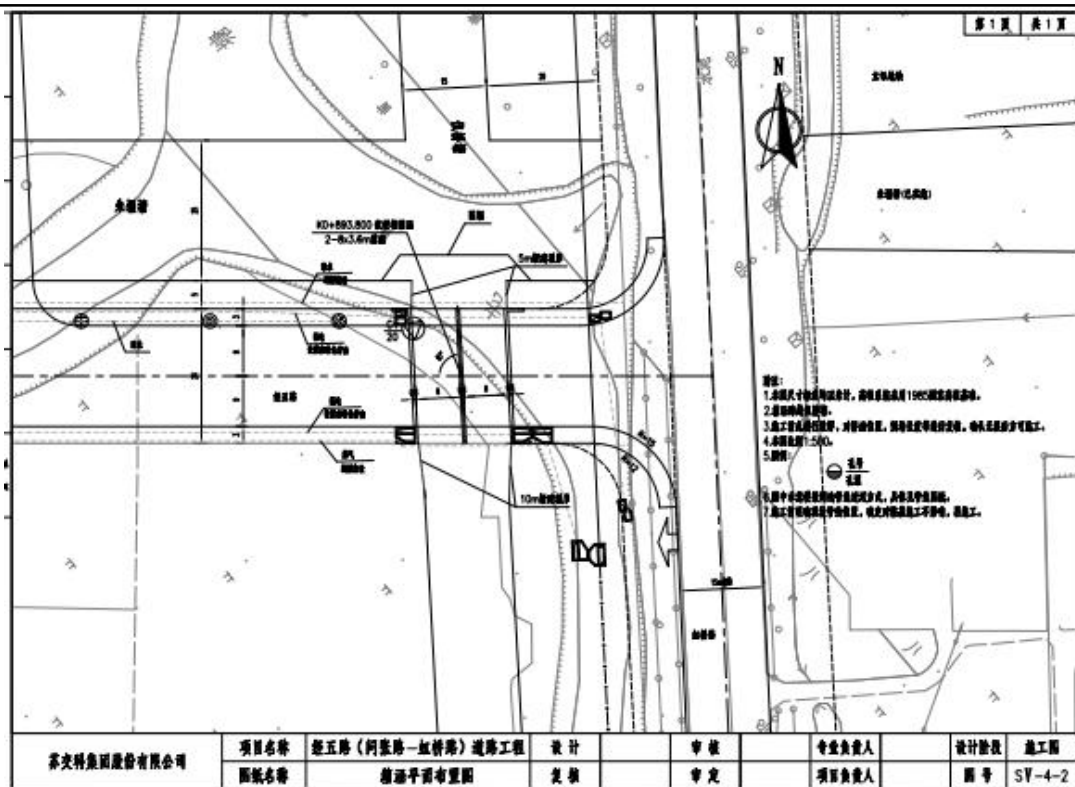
本项目仪桥塘箱涵施工段平面布置图
